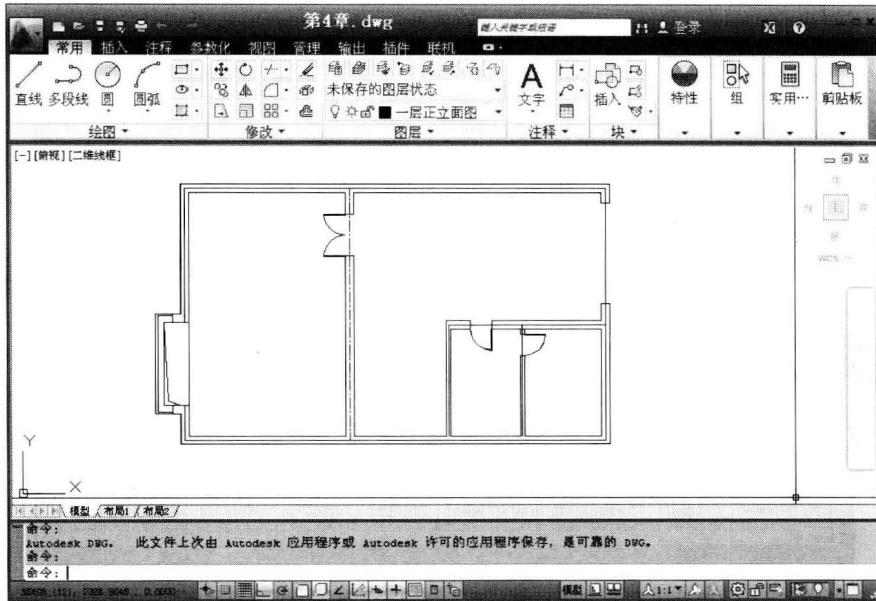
由 AutoCAD 软件绘制的建筑平面图
